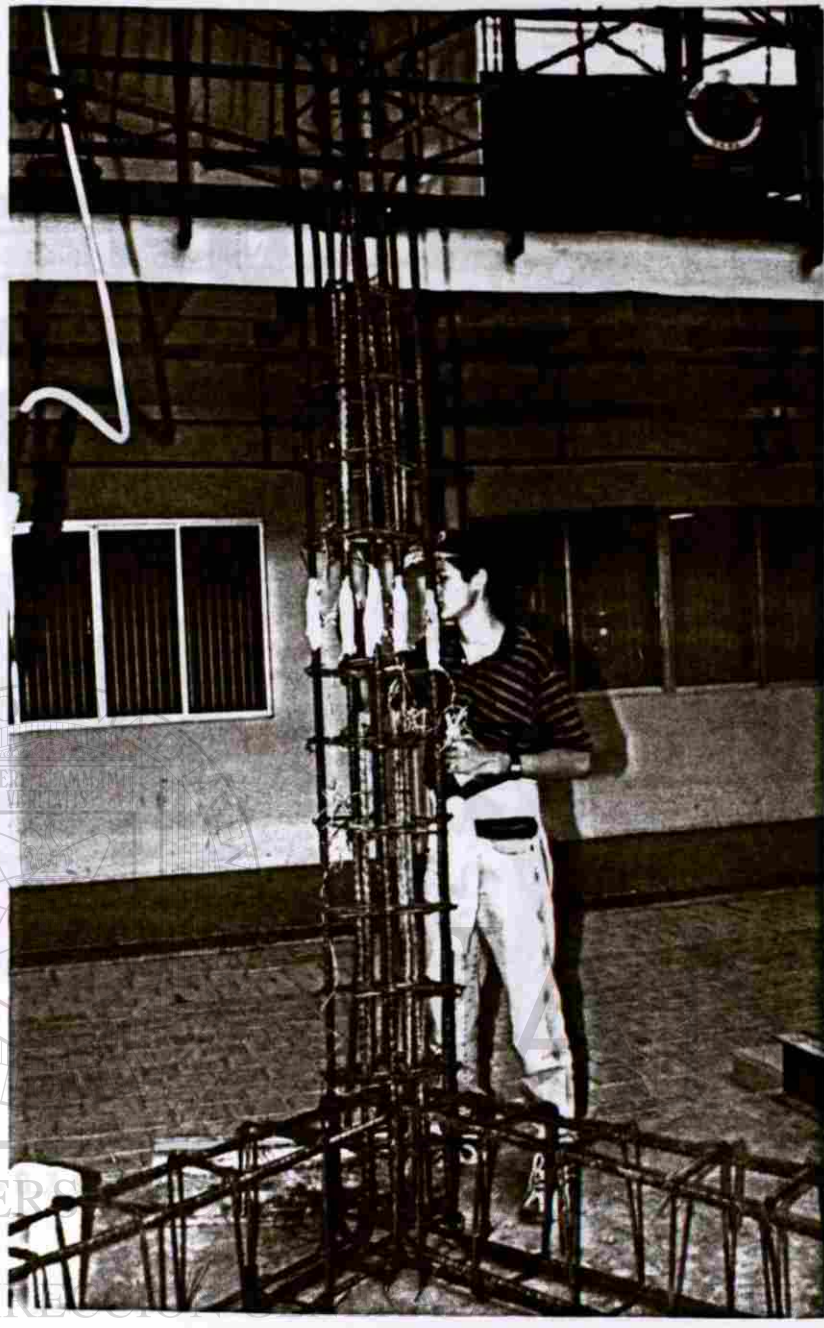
El espécimen de la columna mostrando los brazos para la aplicación del momento en dos direcciones ortogonales.
